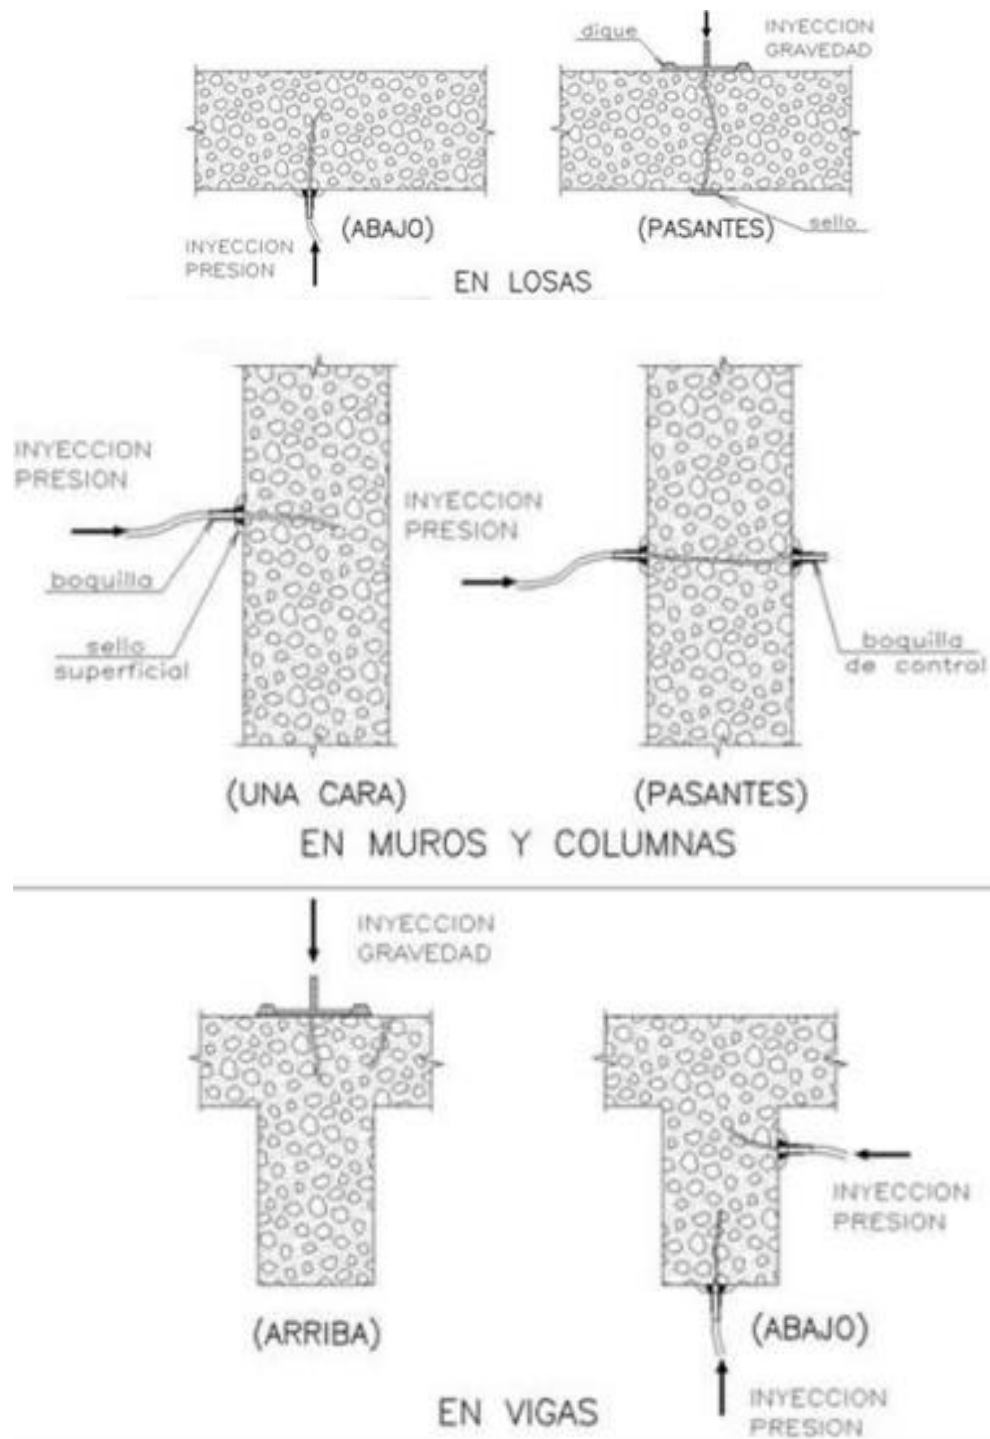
Esquemas de inyección de grietas y fisuras 2
